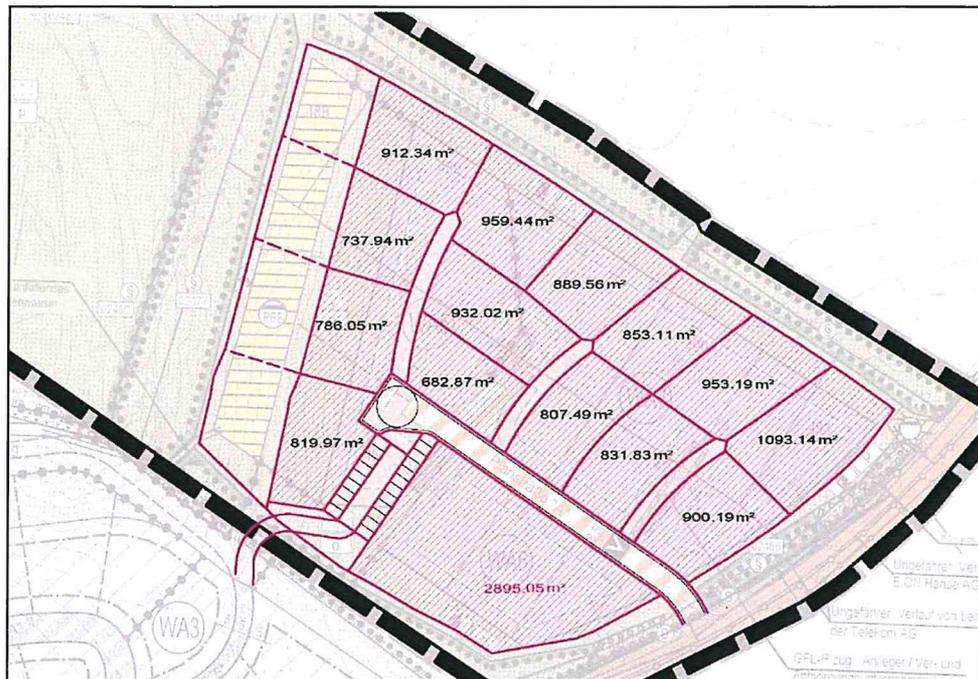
Städtebauliches Konzept- Vorzugsvariante, Planungsbüro Mahnel November 2020
